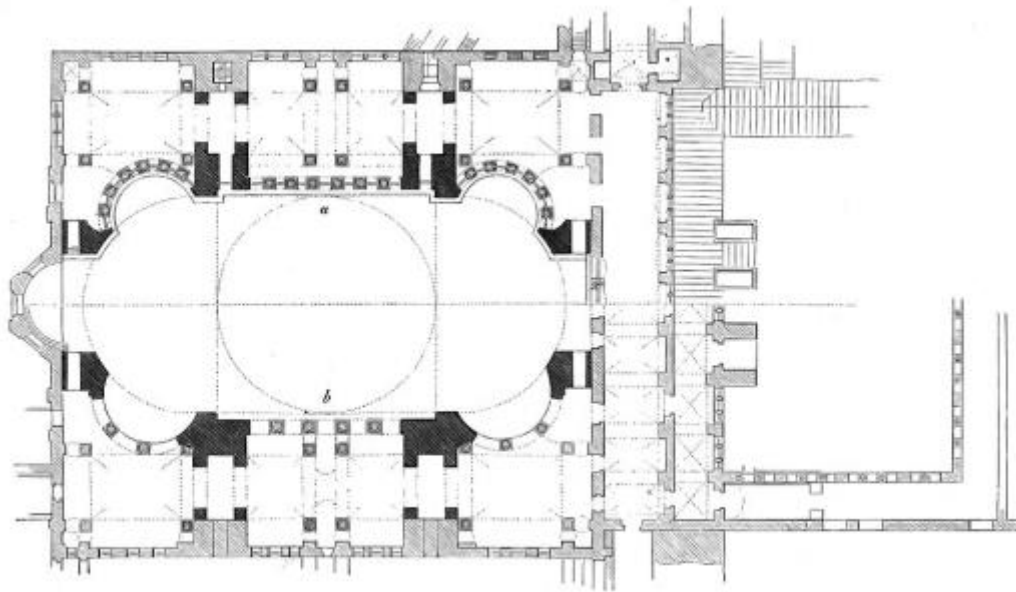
Planta de Santa Sofía de Constantinopla, Estambul, siglo VI.
